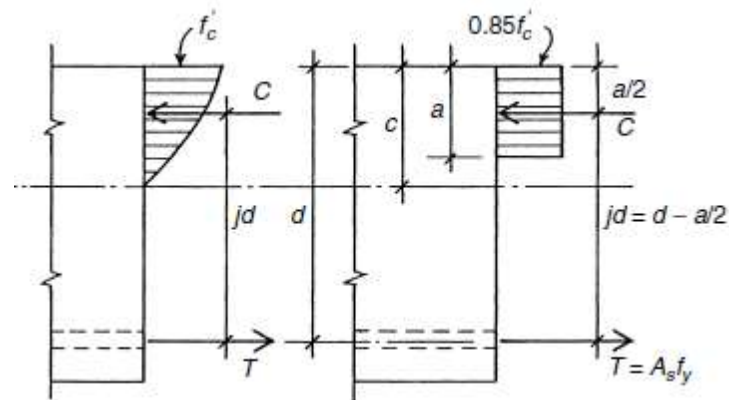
Sección de concreto simplemente reforzado alcanzando la resistencia a la flexión
